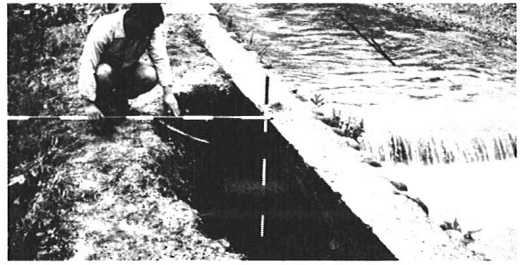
護岸裏の堤体材料のぬけ出し(石川県又江川)
